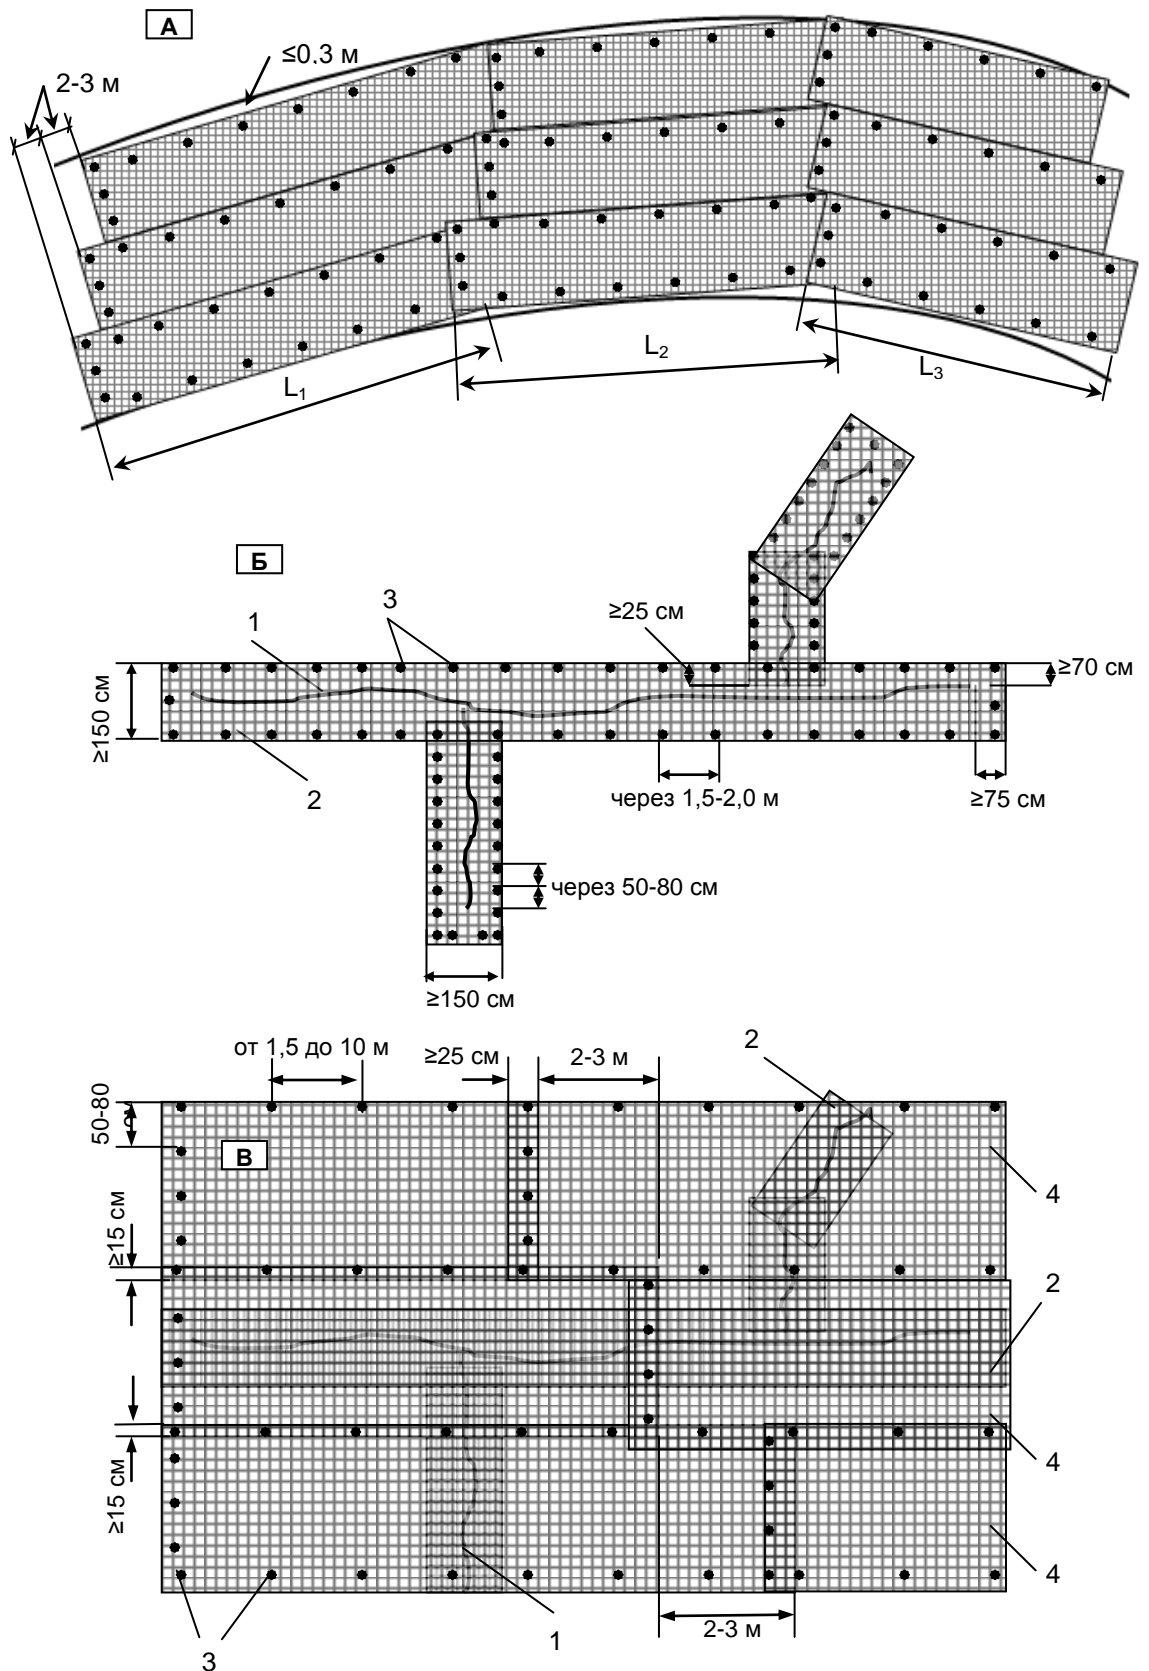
Схемы укладки и крепления полотен и полос геосетки на основании: А – при армировании сплошным полотном на кривых малого радиуса; Б – при армировании полосами над трещинами; В – при комбинированном армировании полосами и сплошным полотном; 1 – продольные и поперечные трещины; 2 – полосы геосетки; 3 – дополнительная фиксация полос к основанию; 4 – полотна геосетки,
